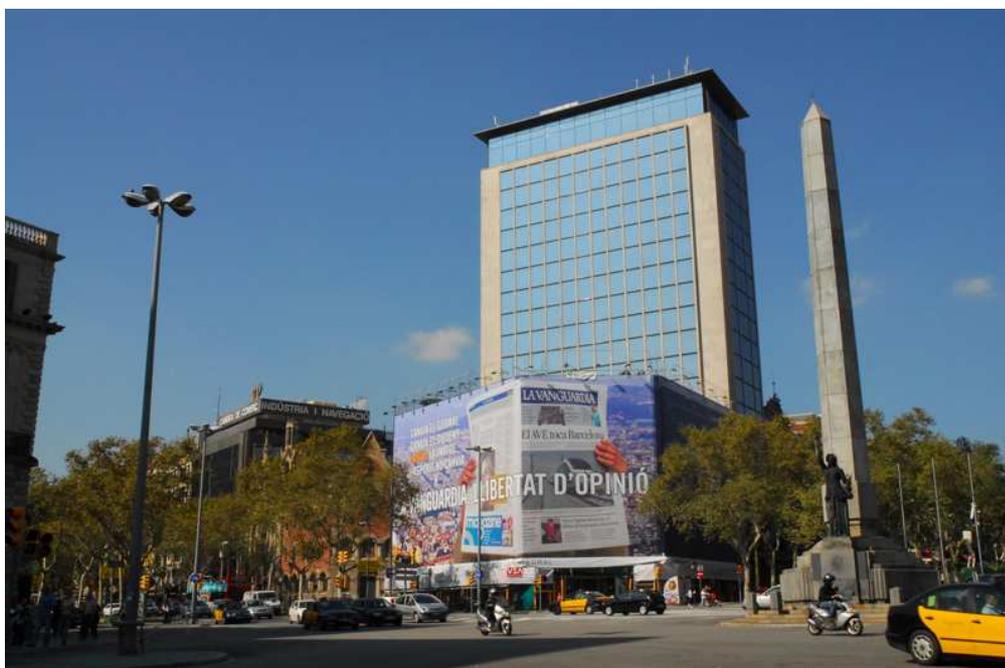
b : Couverture de l'immeuble par des panneaux publicitaires
